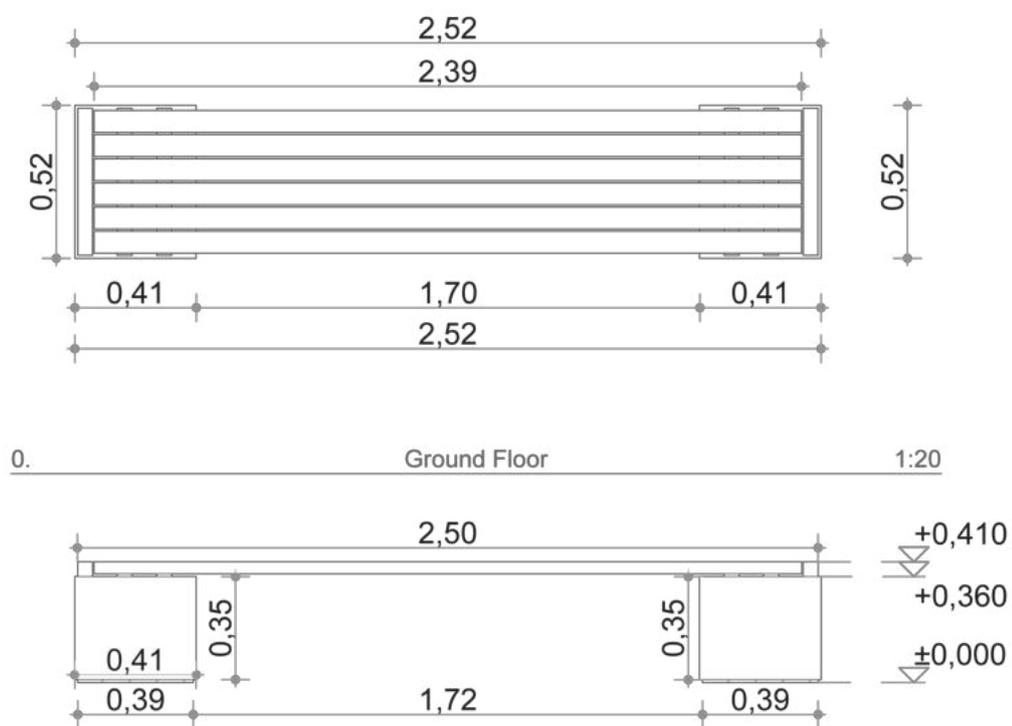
Planos 9 – Planta arquitectónica de Banca Tipo 3. Fuente: Elaboración propia
